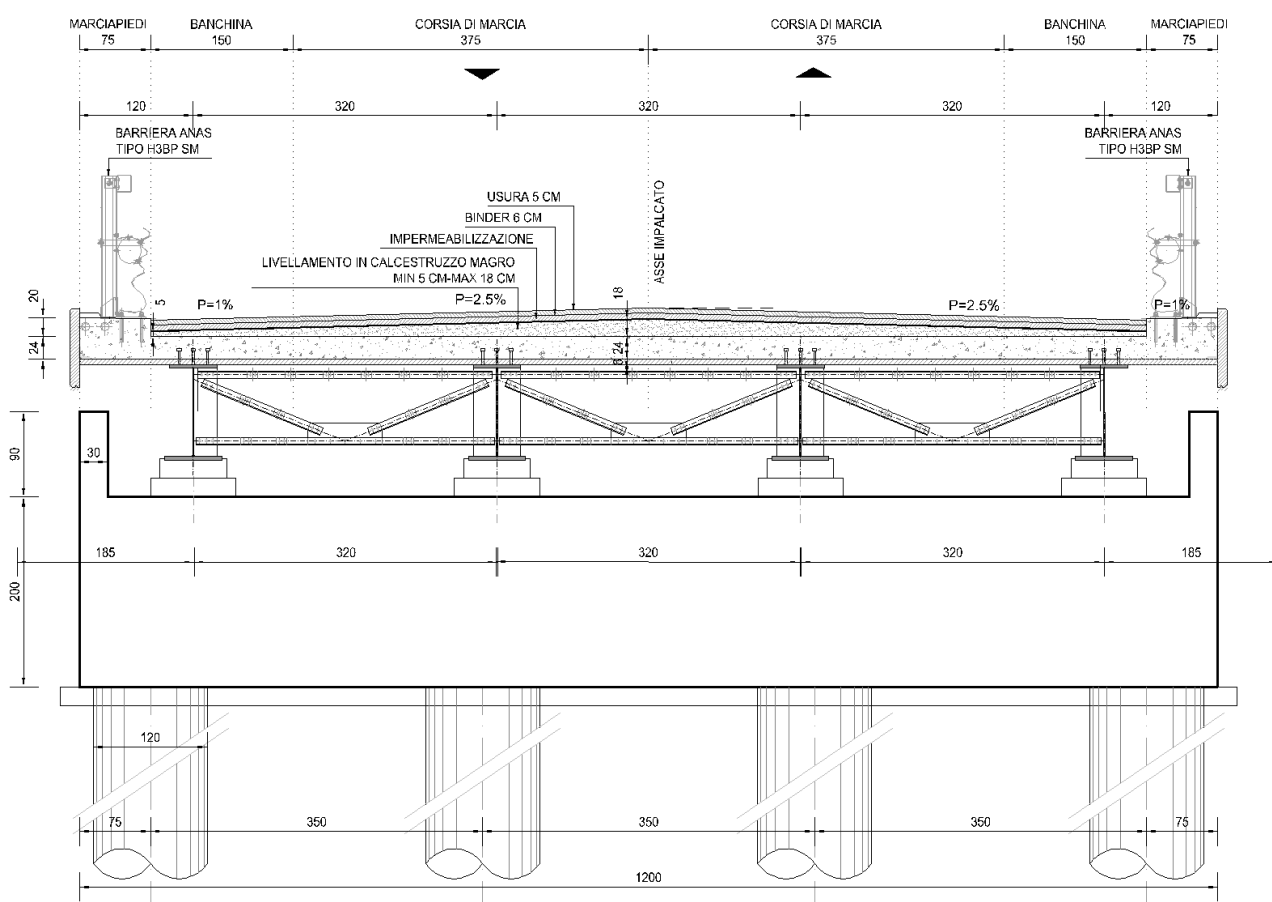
SEZIONE TIPICA IMPALCATO (SU SPALLA)
